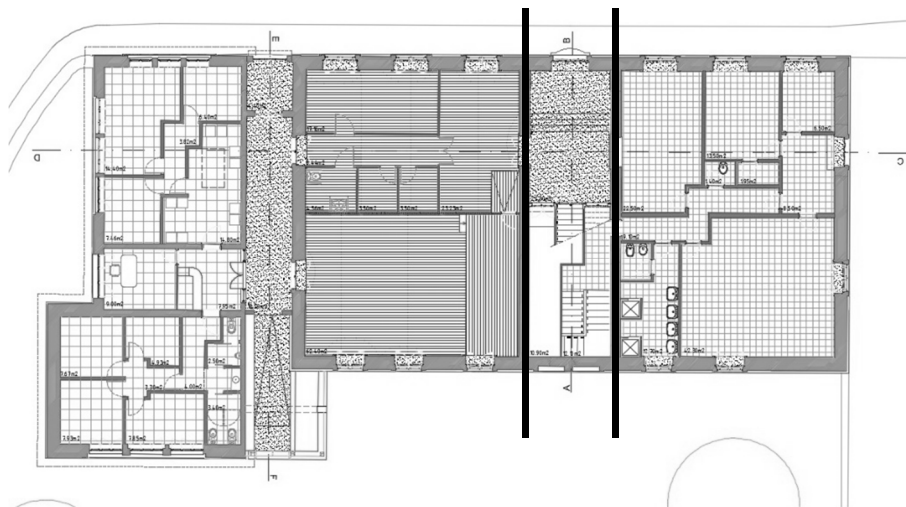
Planta Rés-do-chão (s/escala) – (Autor)
